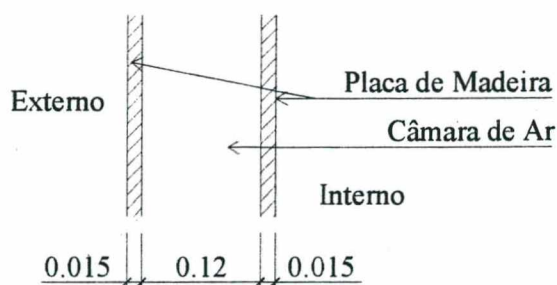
Detalhe Construtivo Parede – Casa 4 (sem escala).
